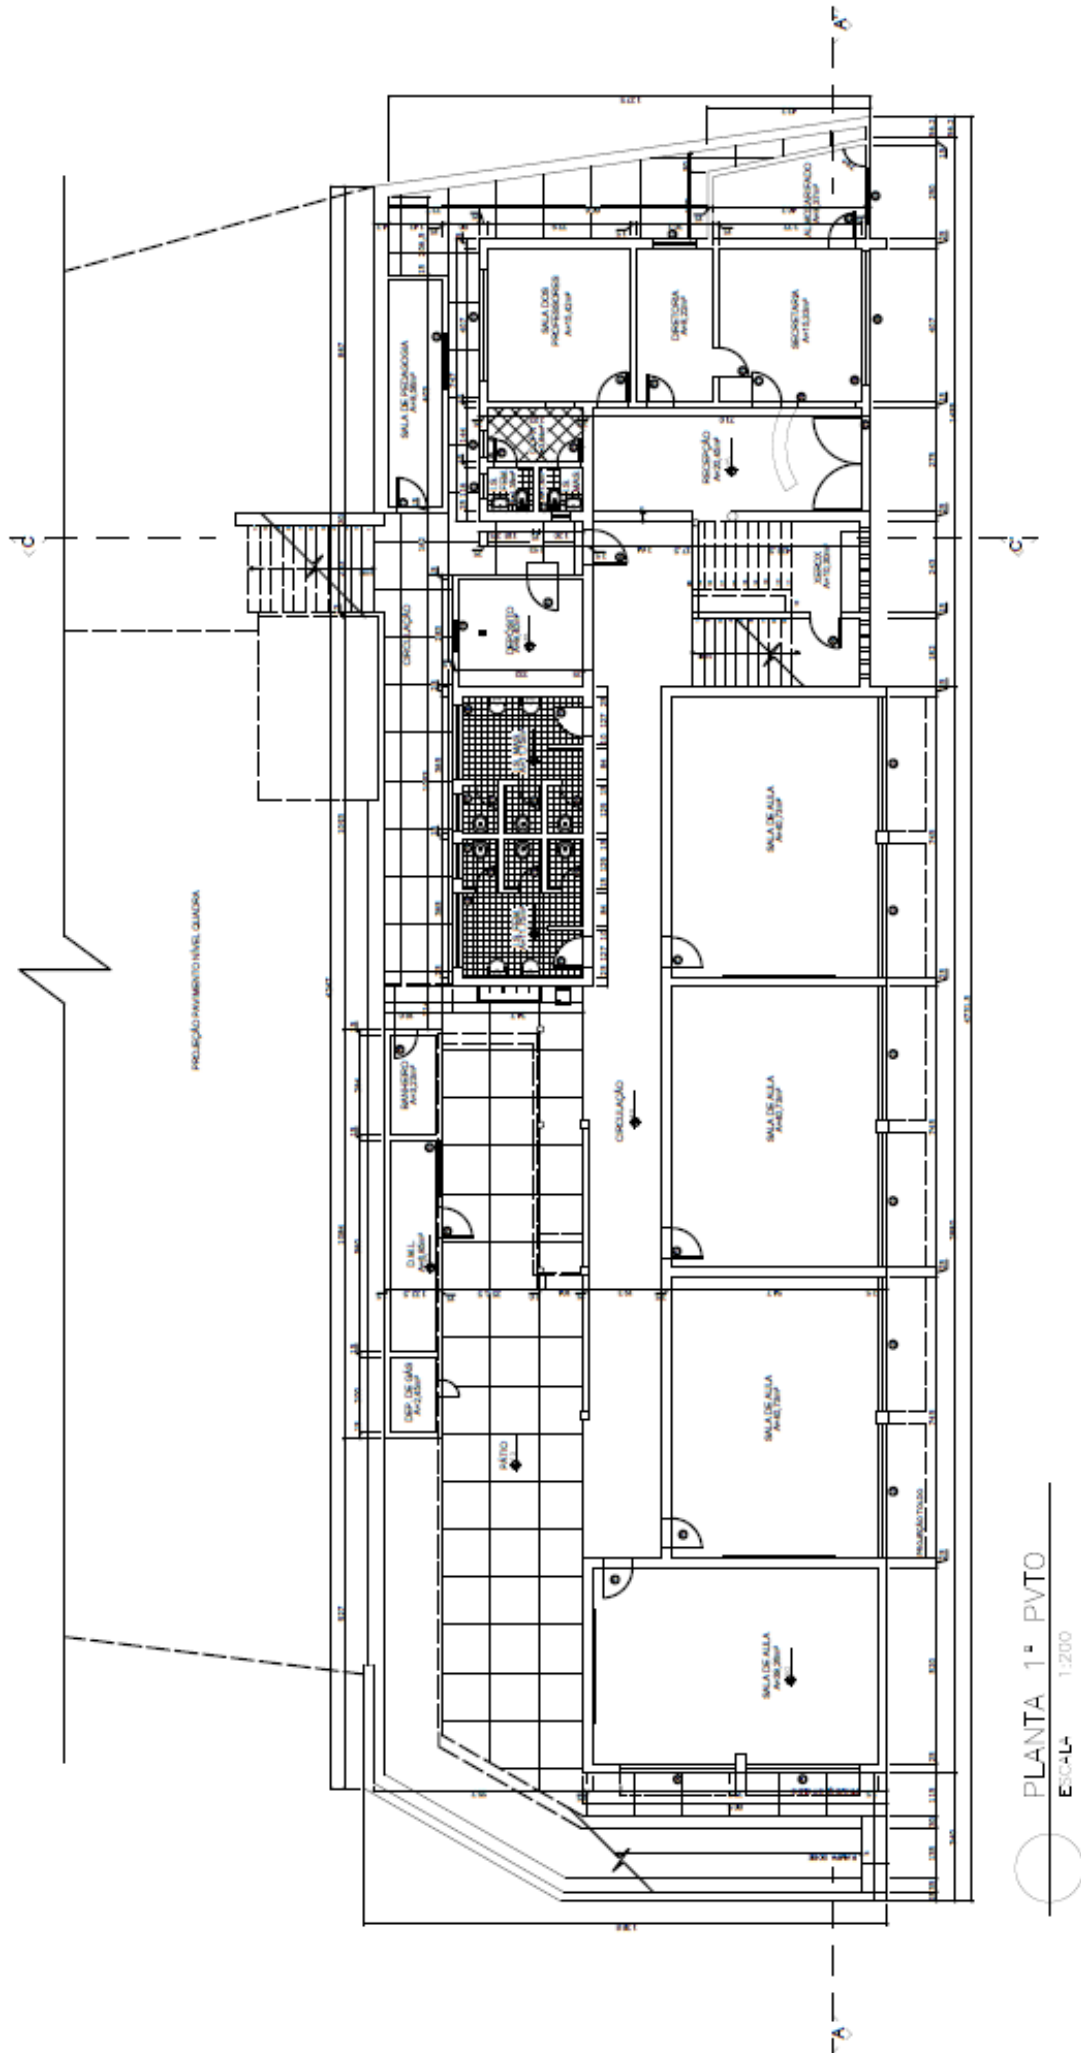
Planta baixa - primeiro pavimento - ESCOLA 1
